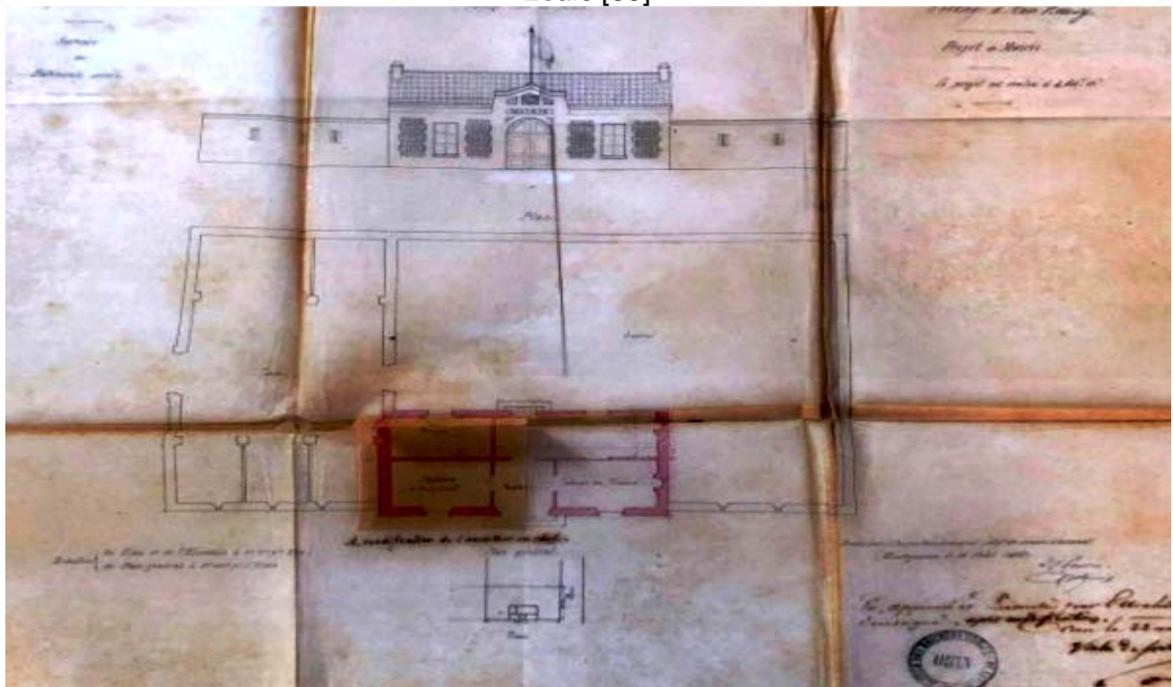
Plan du RDC, façade principale de la mairie d'Aïn Nouissy [85].
